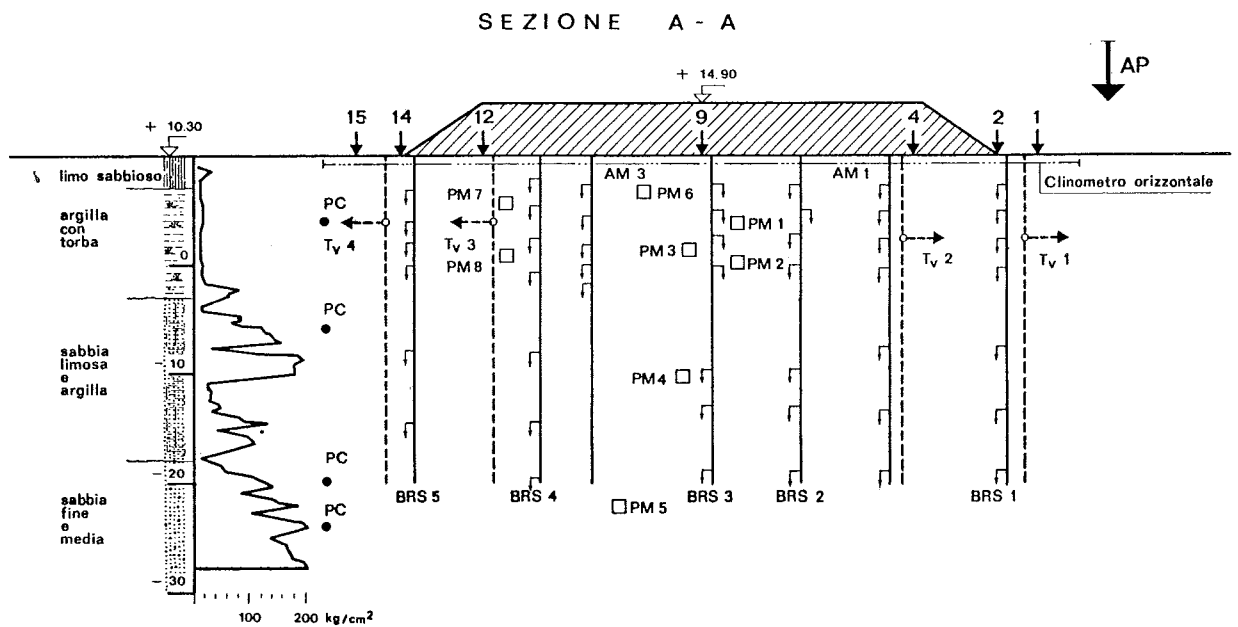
Rilevato sperimentale di Sermide - sezione.
